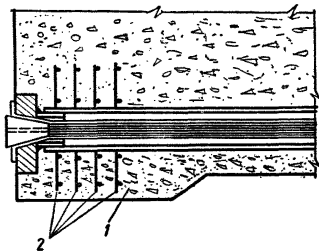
Местное усиление торца предварительно напряженного элемента с пучковой арматурой под анкерами на опорах
